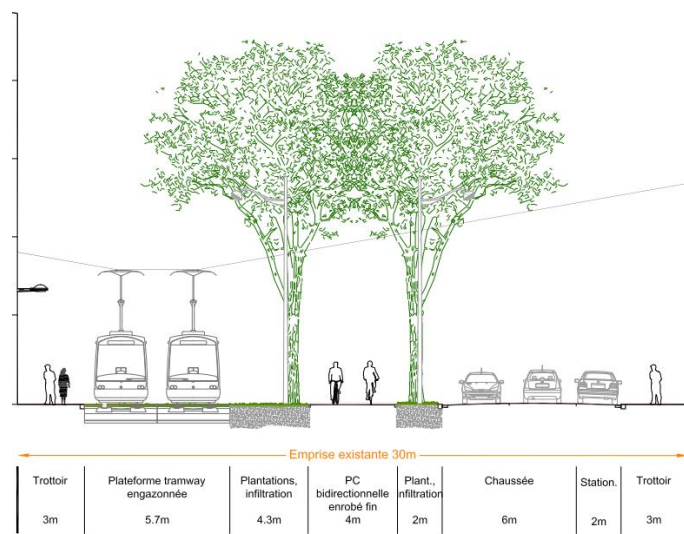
COUPE ET PLAN RUE DE WISSEMBOURG
